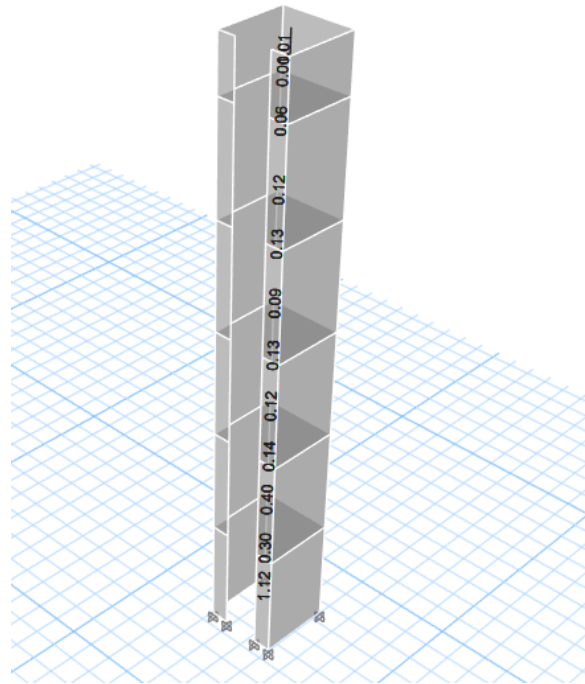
Factores Demanda/Capacidad para columnas. Edificio reforzado
